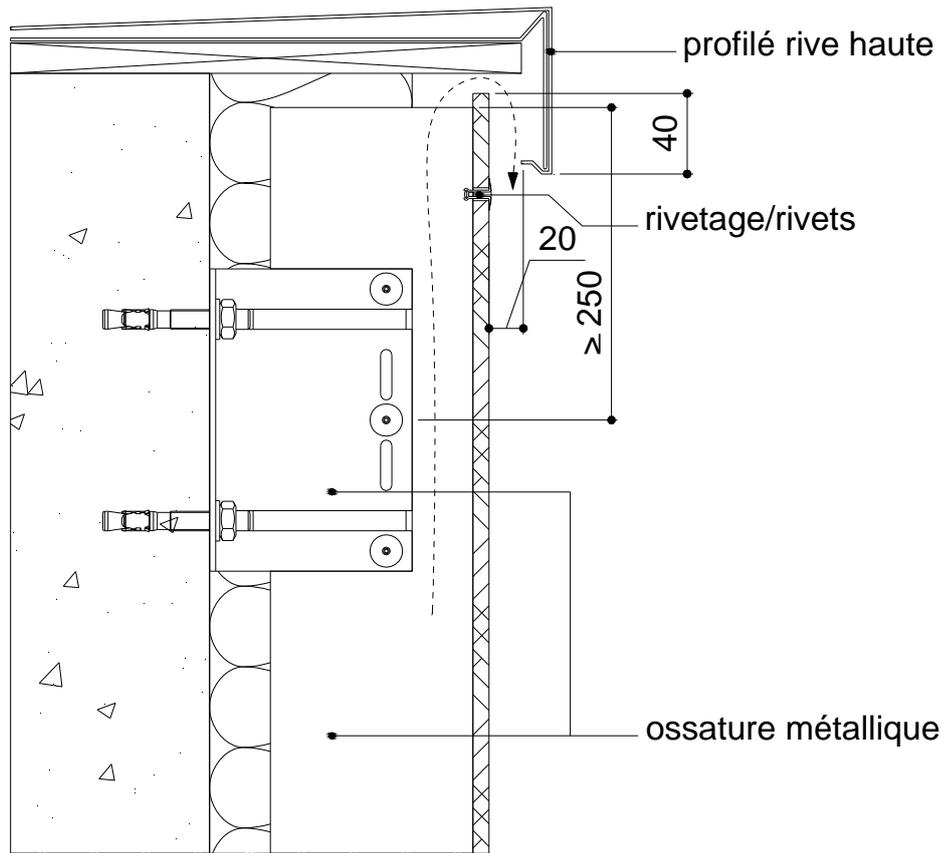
Détail arrêt sur acrotère sur ossature métallique (cote en mm)
